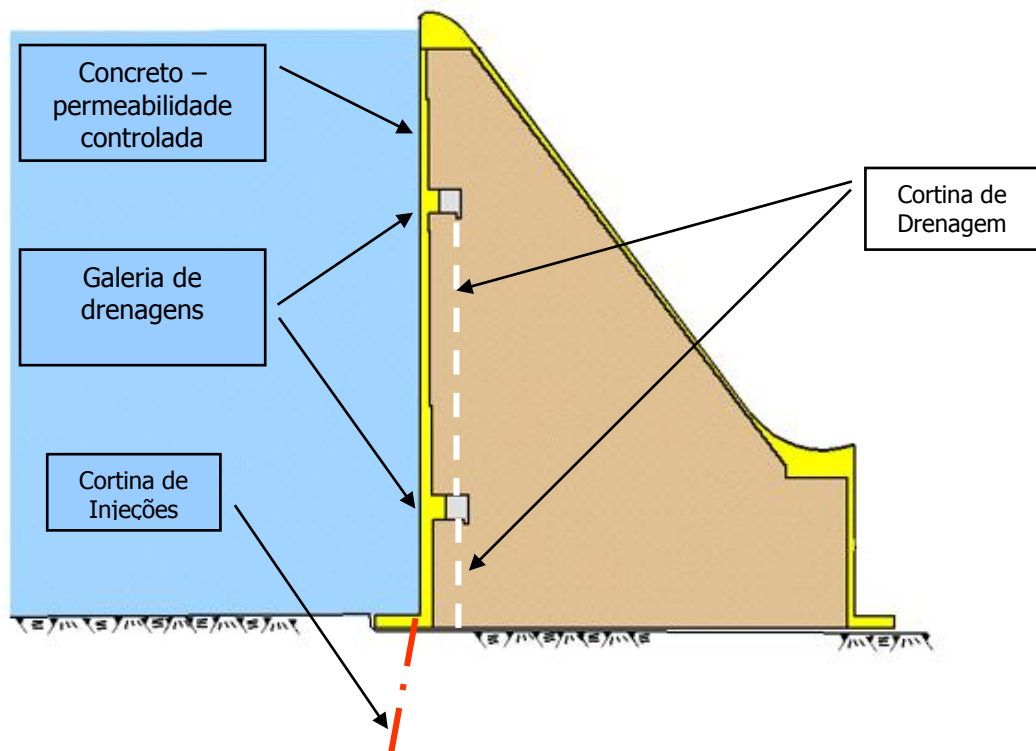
SEÇÃO TÍPICA DE BARRAGEM DE CONCRETO A GRAVIDADE
